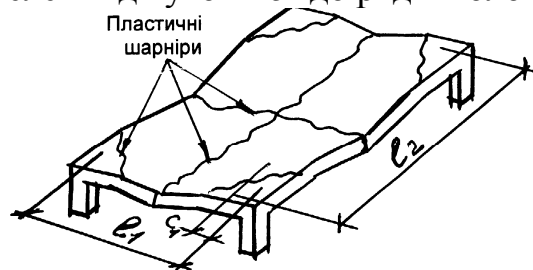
Утворення пластичних шарнірів у безбалковому перекритті при суцільному навантаженні
